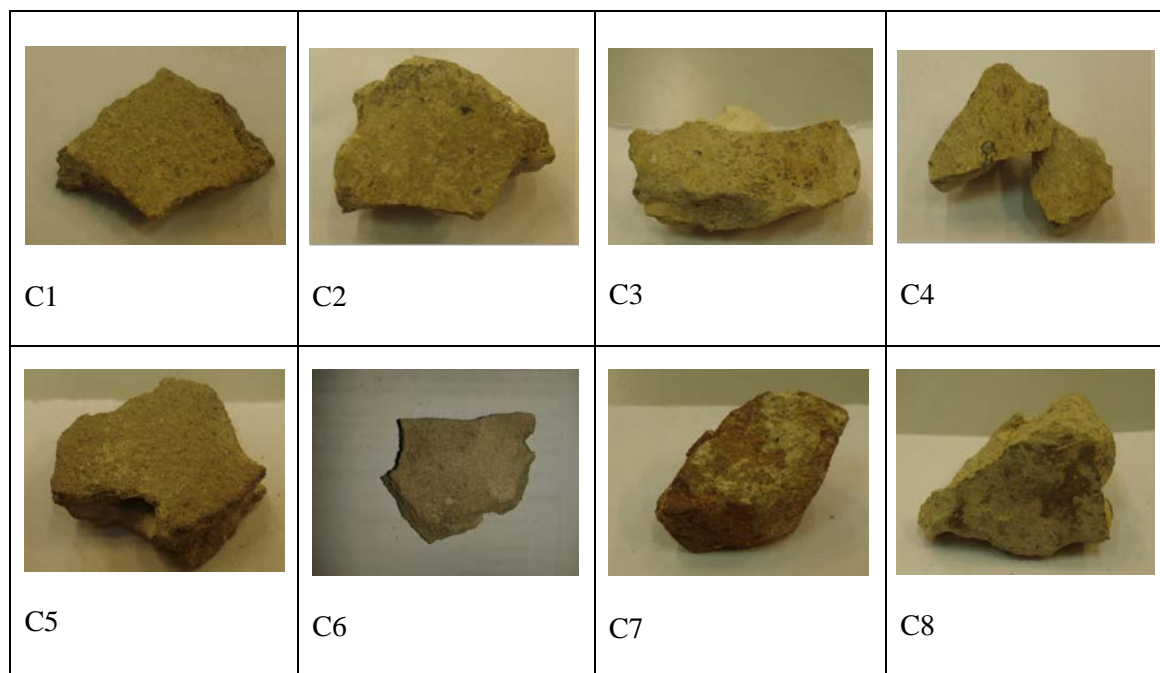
Immagini dei campioni prelevati dal pavimento della Chiesa e dall'altare (C7).
